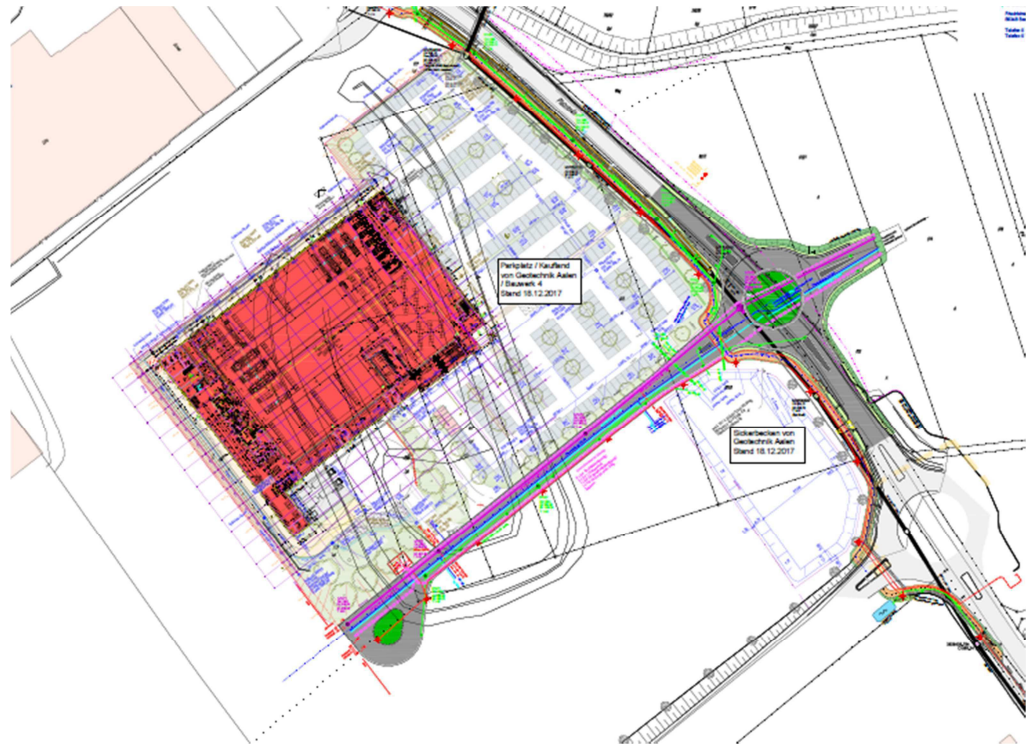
Neu geplanter Kreisverkehr in der Planstraße
